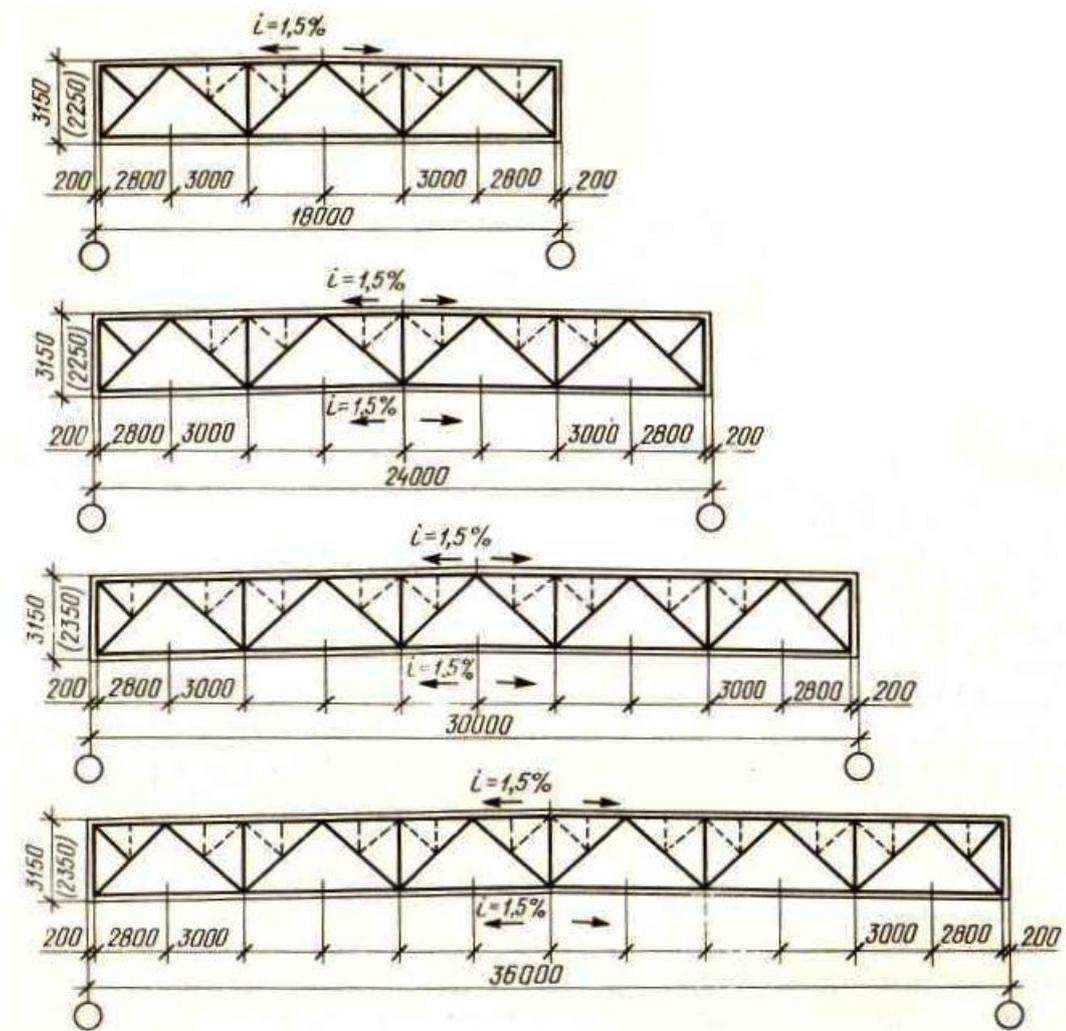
Малоуклонные фермы из горячекатаных профилей (в скобках указаны размеры ферм пониженной высоты)
